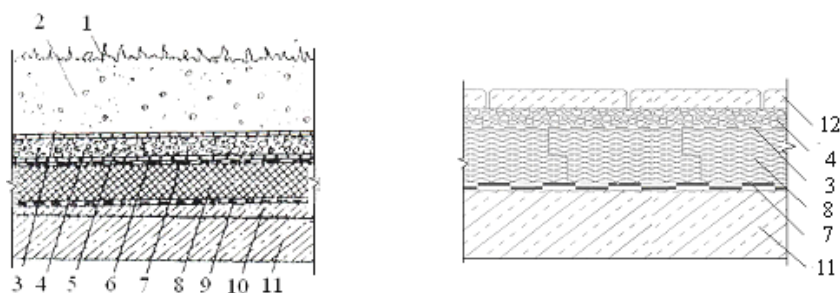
Устройство на плоской крыше растительного газона (а) и тротуарной плитки (б) по инверсионной кровле:
